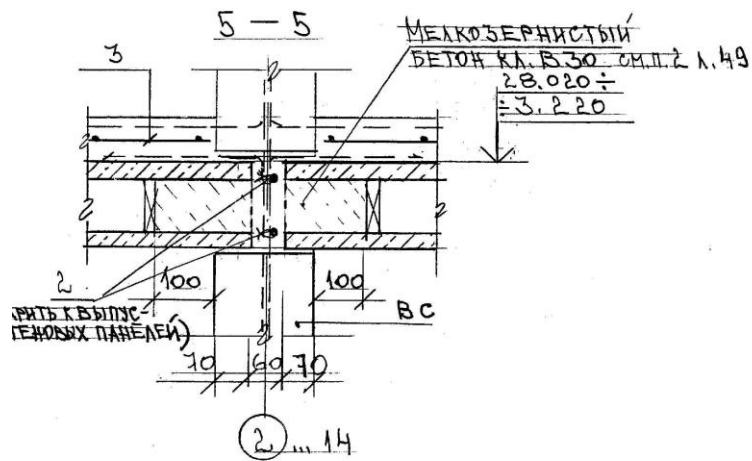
Обпирання багатопустотних плит на внутрішню стіну
